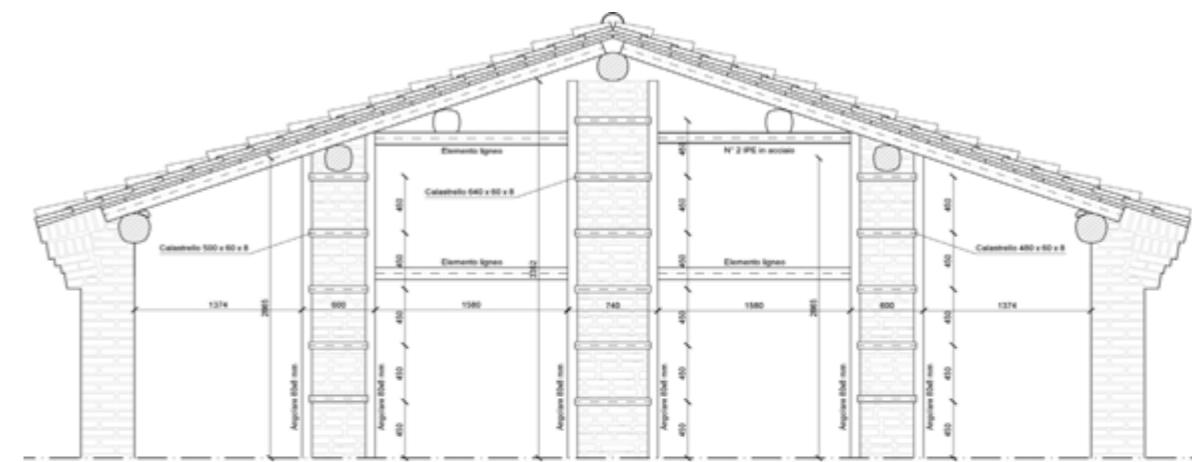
I tre pilastri in muratura del sottotetto in seguito all'intervento di cerchiatura di confinamento.
